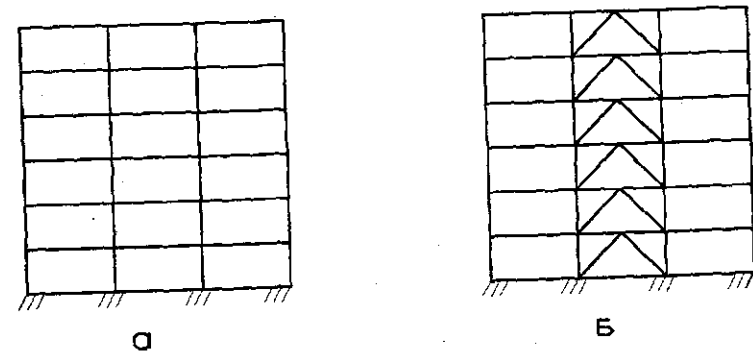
Усиление поперечной рамы связями: а — рама; б — рама со связями
